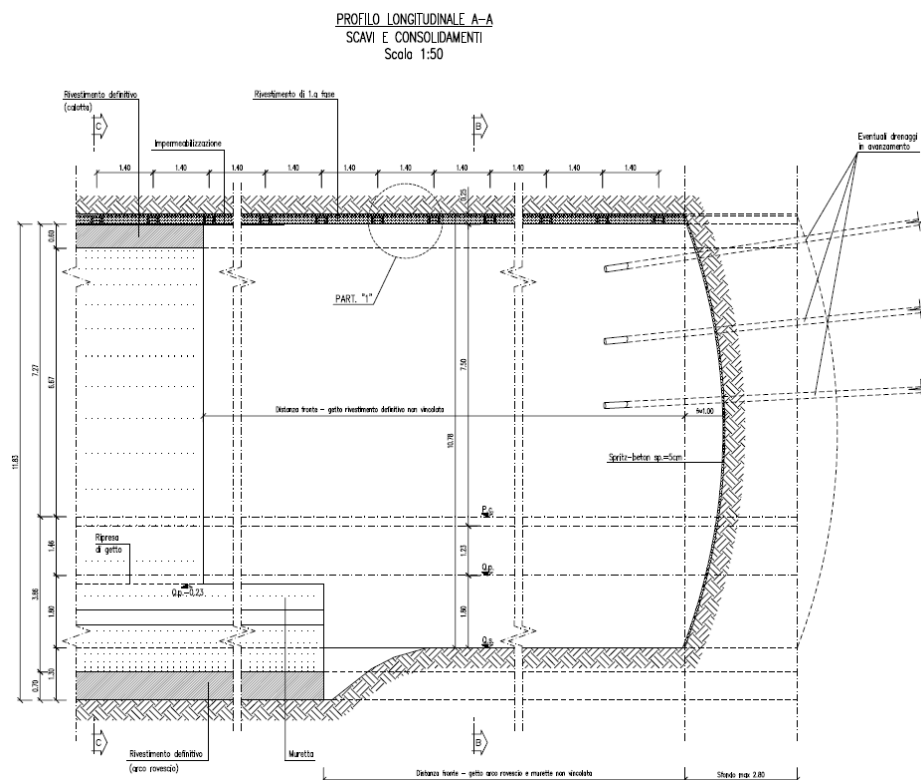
Sezione tipo Ac (profilo longitudinale)
